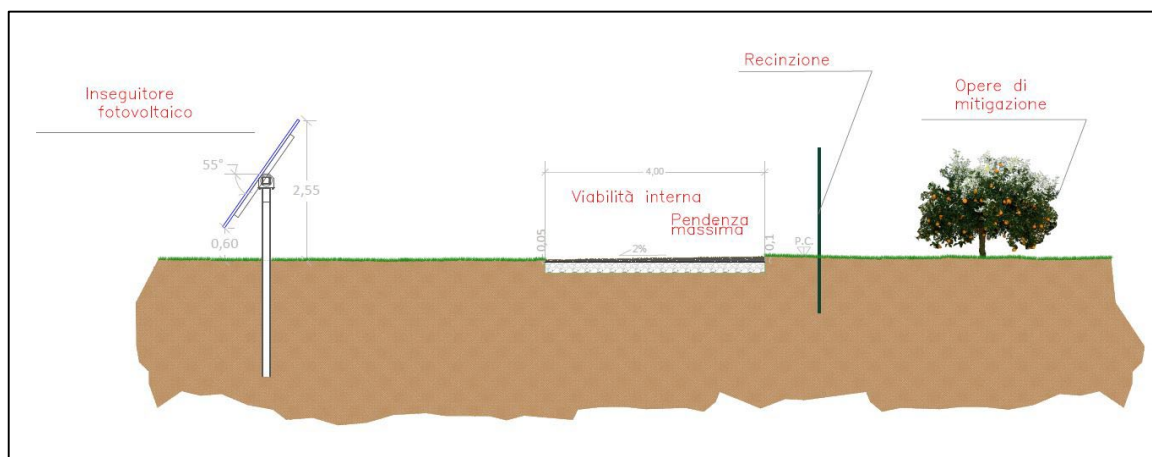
schema della fascia di rispetto con recinzione, elementi arborei e muretti
